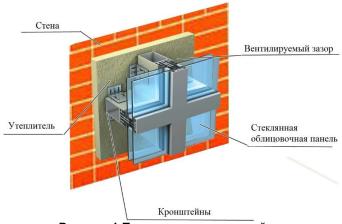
Пример конструктивной схемы стеклянного вентилируемого фасада
